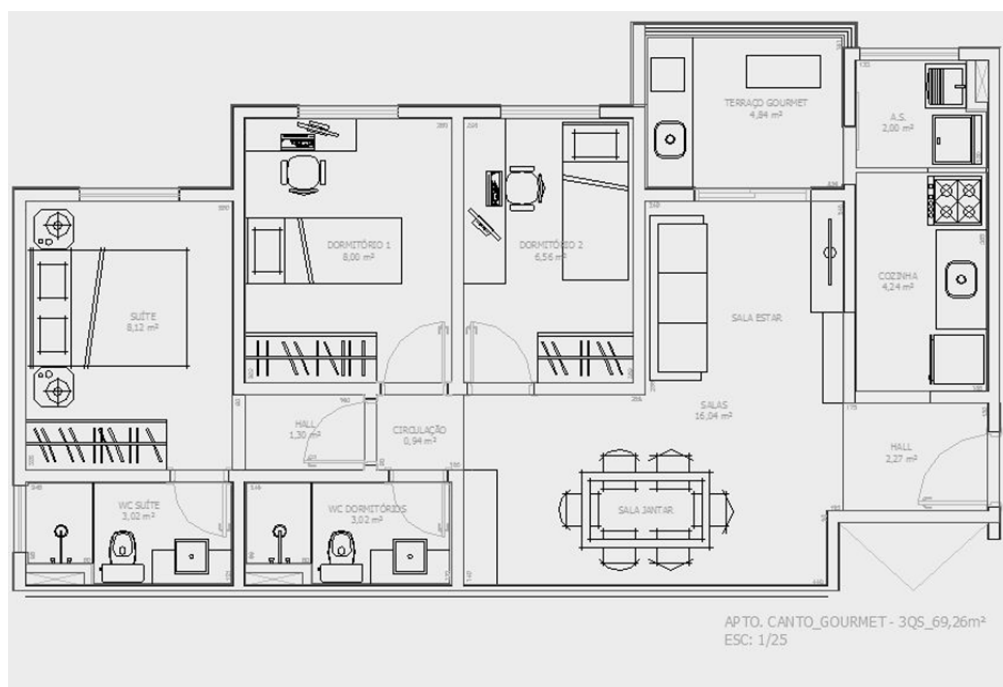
Planta do apartamento de 2 dormitórios e 1 suíte com mobiliário. Exemplo.
